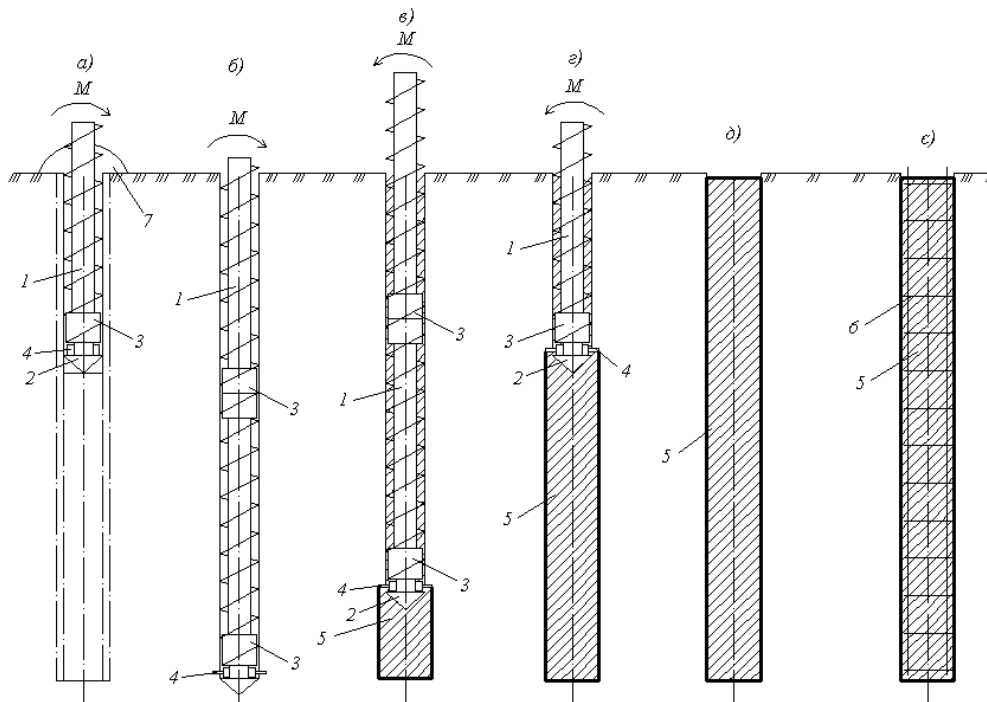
Технологічна схема влаштування ґрунтоцементних паль з частковим вийманням ґрунту: а) буріння свердловини першим шнеком; б) буріння з нарощуванням шнеків; в) перший прохід шнека з розчином; г) перемішування ґрунтоцементу на ділянці; д) палі з перемішаним ґрунтобетоном; е) занурення арматурного каркаса у ґрунтобетон: 1 – шнеки; 2 – наконечник; 3 – муфта з’єднання; 4 – розкладні ножі; 5 – ґрунтобетон; 6 – арматурний каркас; 7 – ґрунт.
